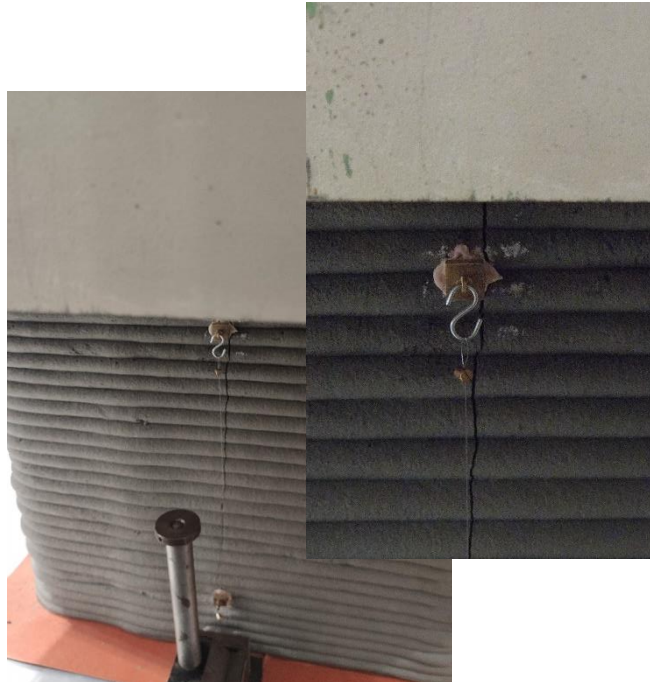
Modelo 1 - fissura (e pormenor) a meio vão com carga aplicada de cerca de 100 kN
